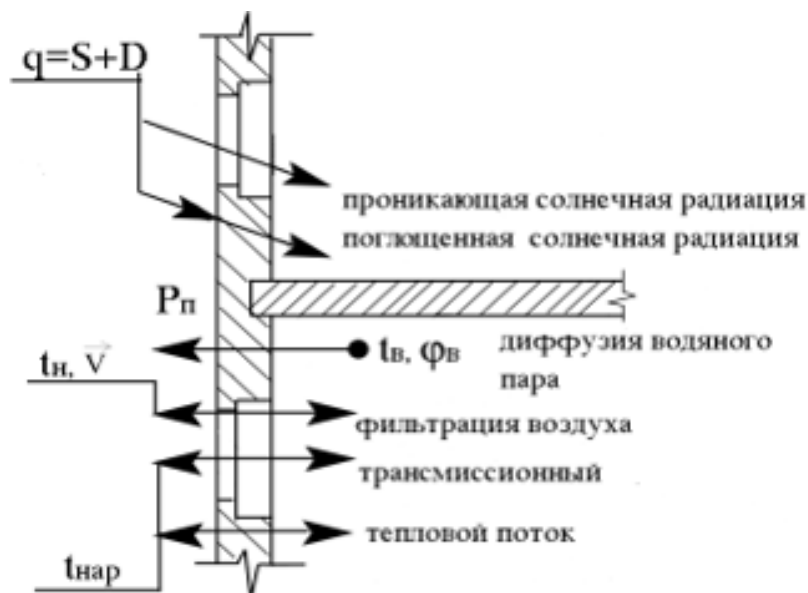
Схема воздействия наружной среды на тепло-массопередачу наружных ограждений
